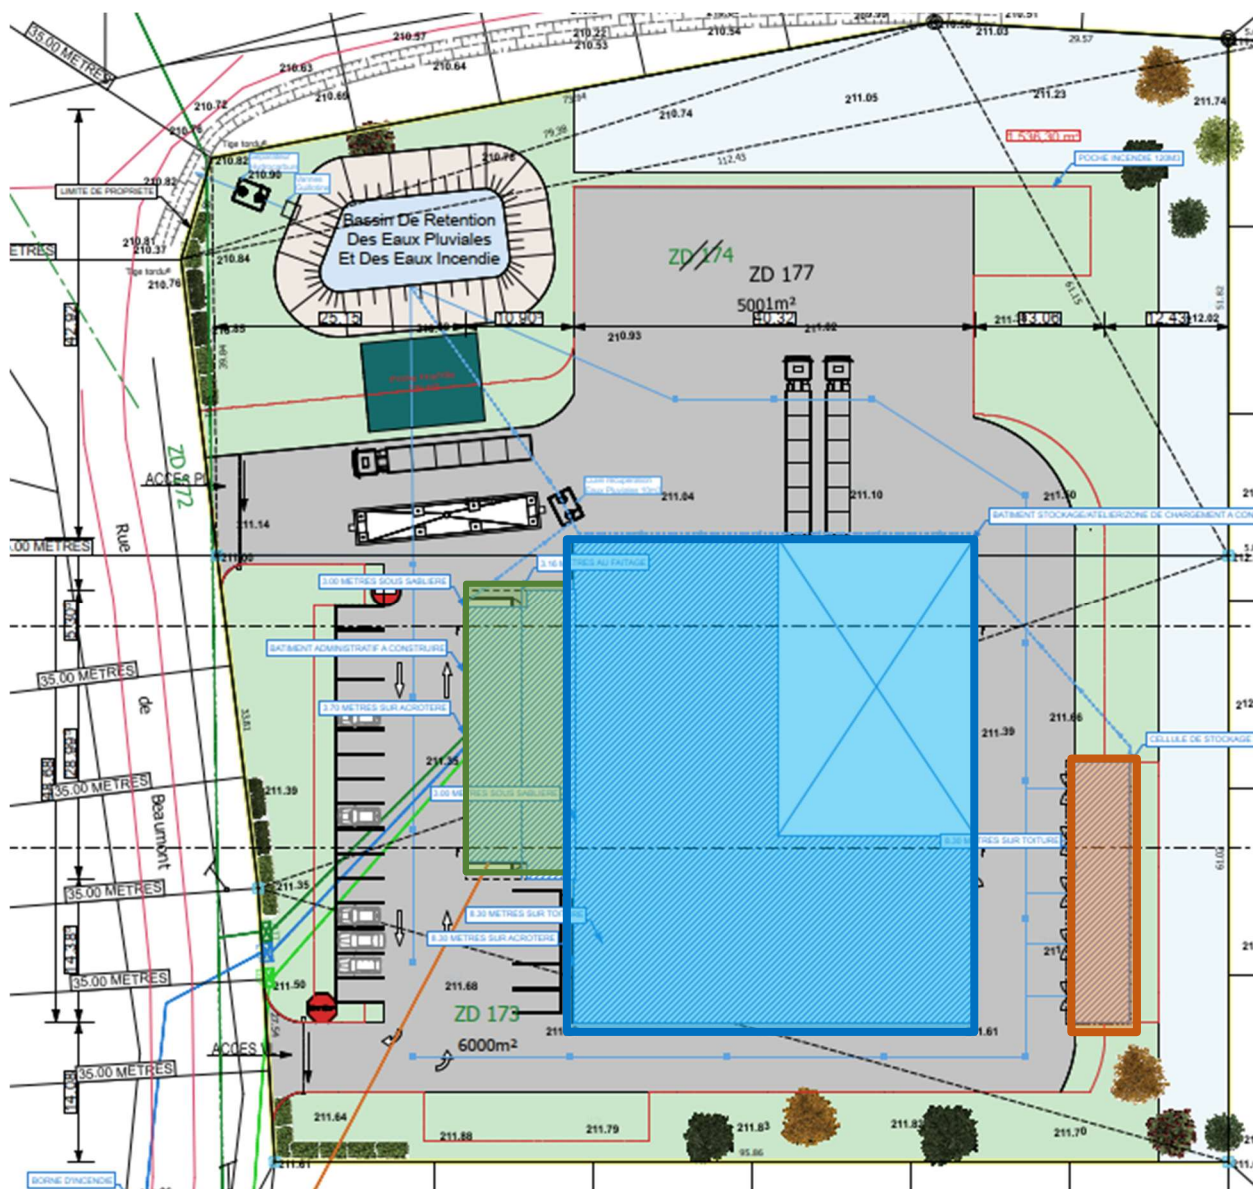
PLAN DU SITE (SOURCE : ADLCA, ECHELLE : NON CONTRACTUELLE)
